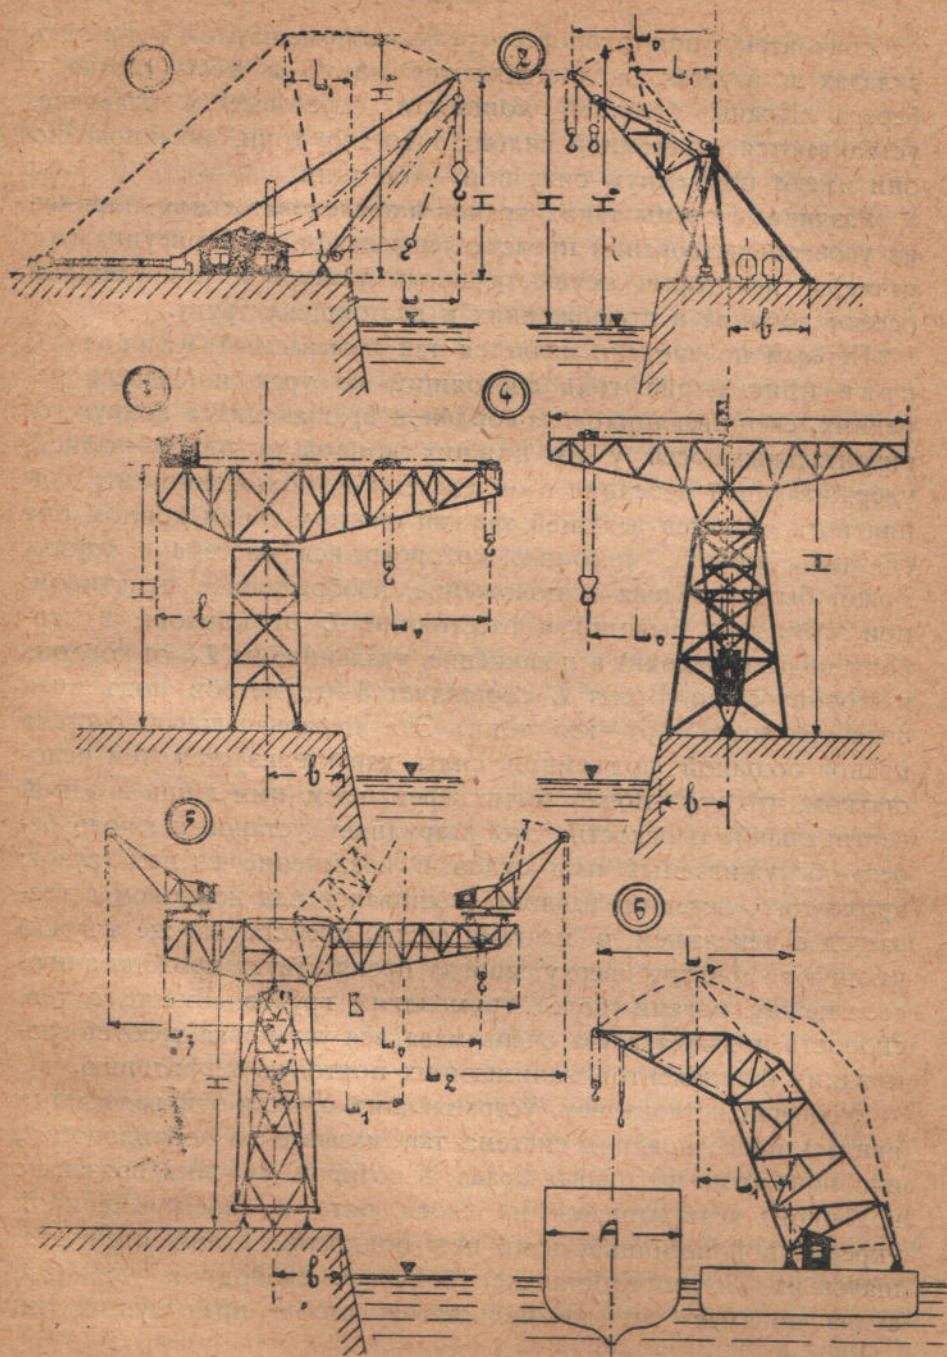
Схемы портовых кранов большой мощности: 1. Мачтовый береговой кран; 2. Дерриктовый береговой кран; 3. Поворотный порталный или башенный кран;—4. Молотковый кран;—5. Молотковый колокольный кран;—6. Плавучий кран.
